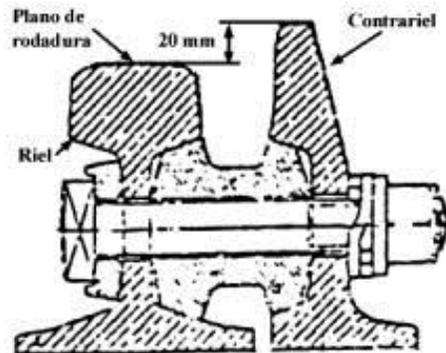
Elevación del contrarriel sobre el plano de rodadura.
